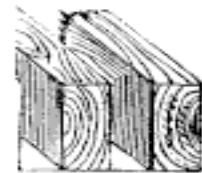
Coupé transversale des barres d'un plancher à claire-voie.
